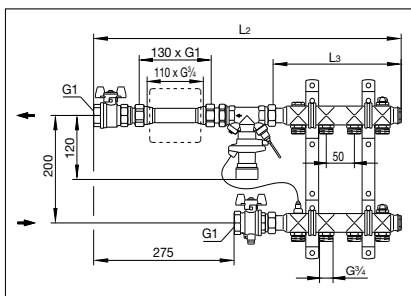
Set di collegamento contacalorie Set 2, diritto e collettore inox „Multidis SH“ per collegamento radiatori, lunghezze d'installazione
